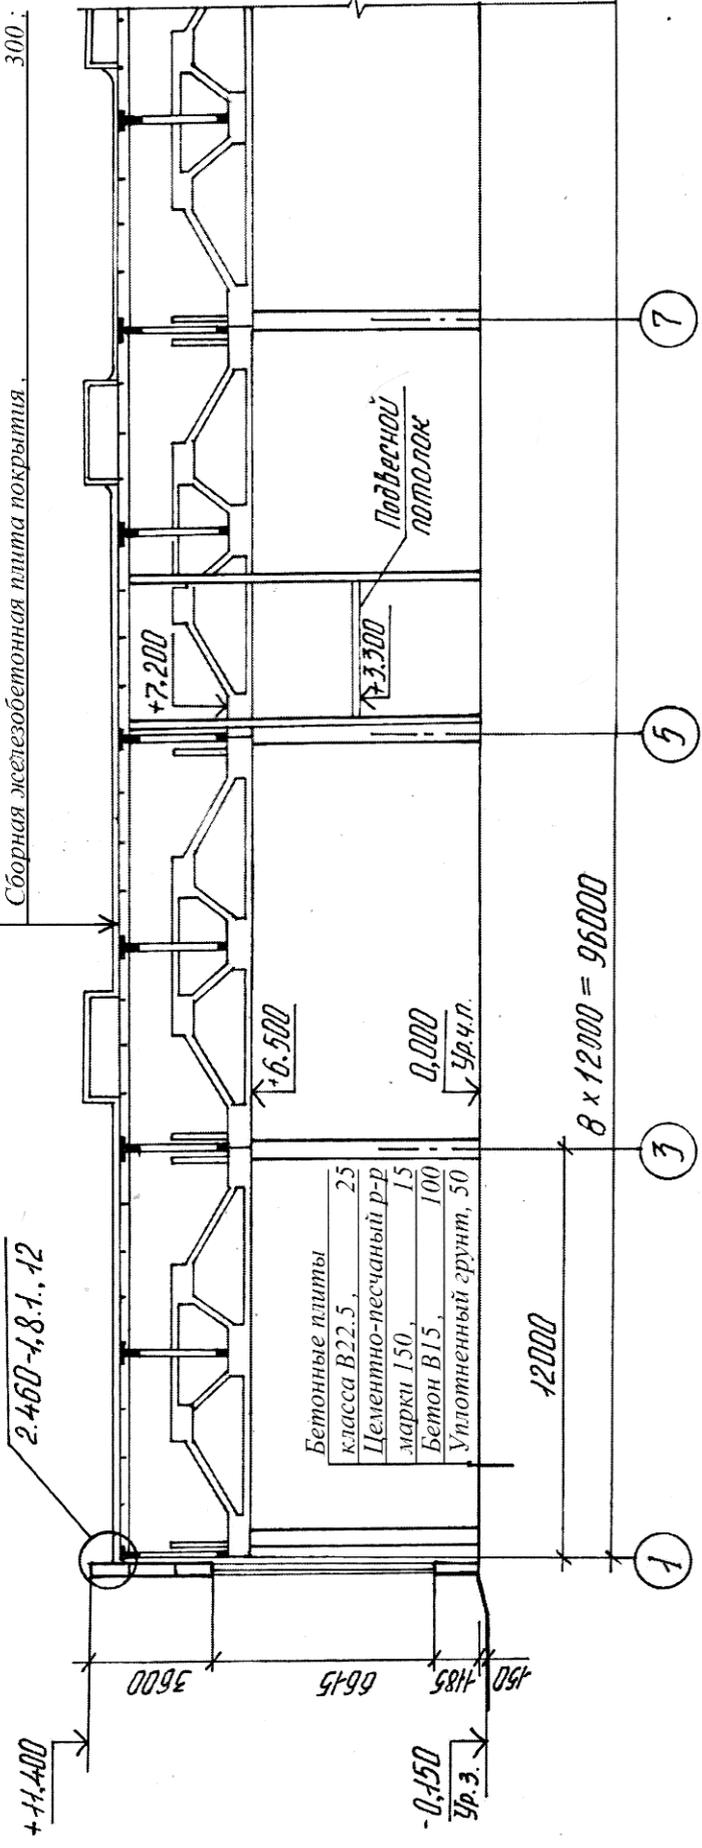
Пример выполнения продольного разреза производственного здания с безраскосной железобетонной сегментной фермой и зенитными фонарями
